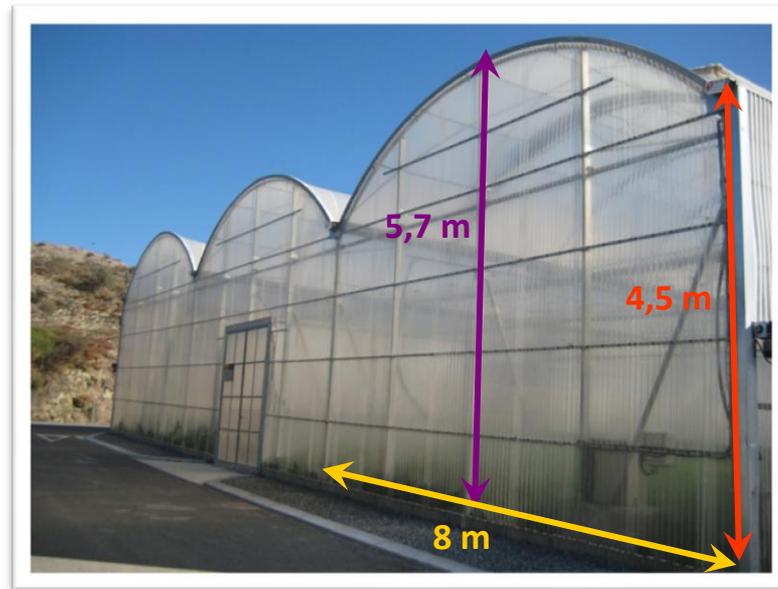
Croquis de las dimensiones estructurales de los invernaderos. EP.
